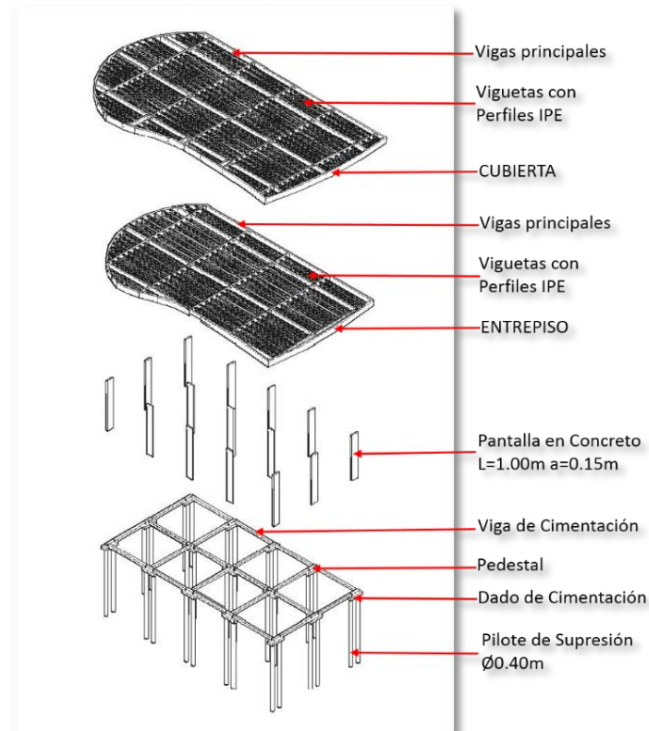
Axonometría de Elementos Constructivos Edificio 2
